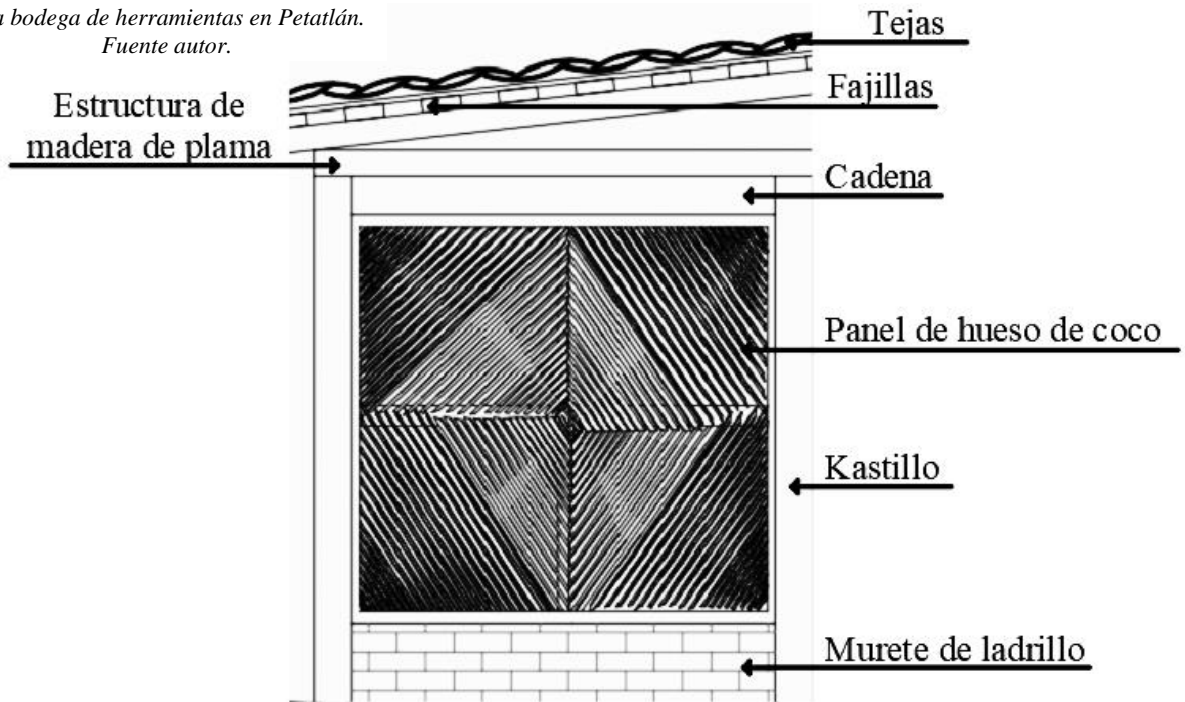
Despiece de muros y cubierta de la vivienda. Fuente autor.
